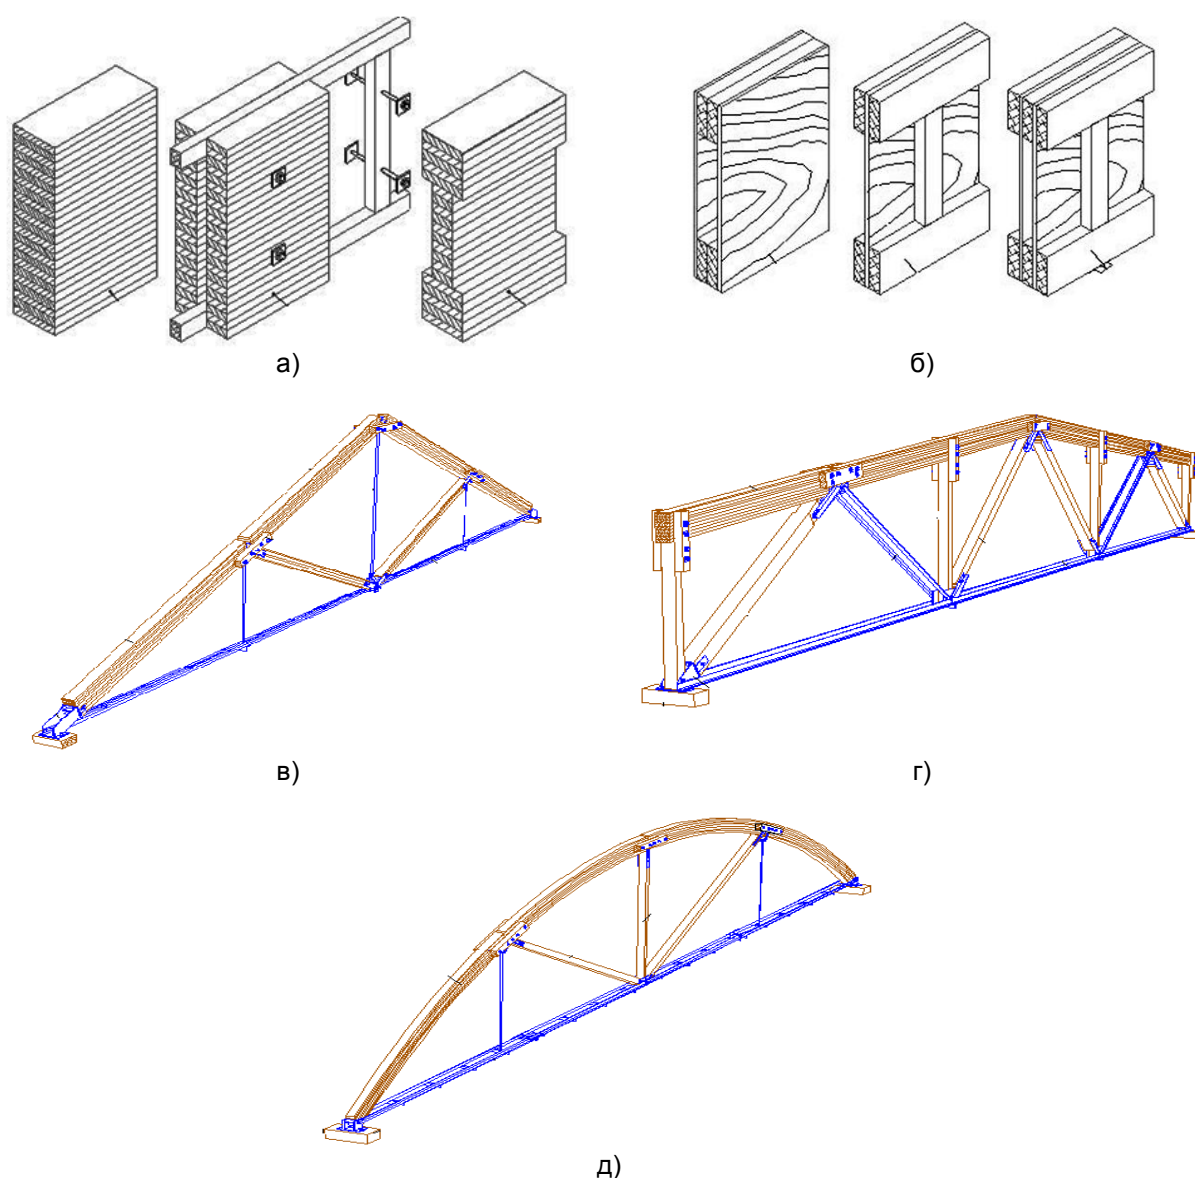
Клееные деревянные конструкции: а) дощатоклеенные; б) клефанерные; в-д) треугольная, трапецевидная сегментная металлодеревянные фермы соответственно
